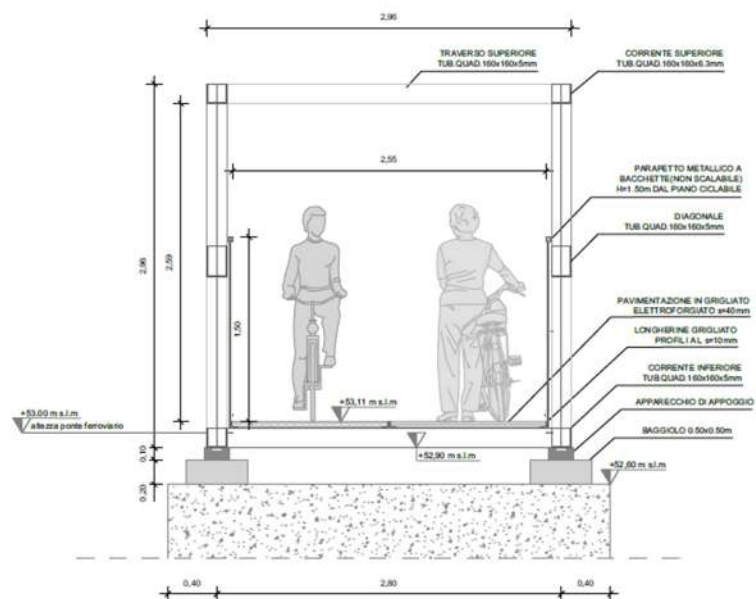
Passerella ciclopedonale – Sezione trasversale
